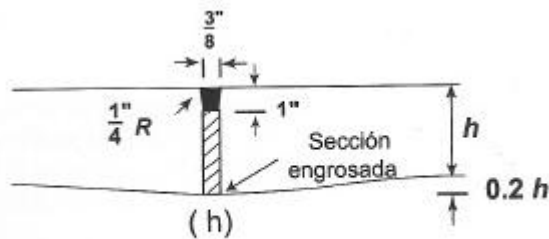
b.17 Junta de expansión sin dispositivo de transferencia de carga.
